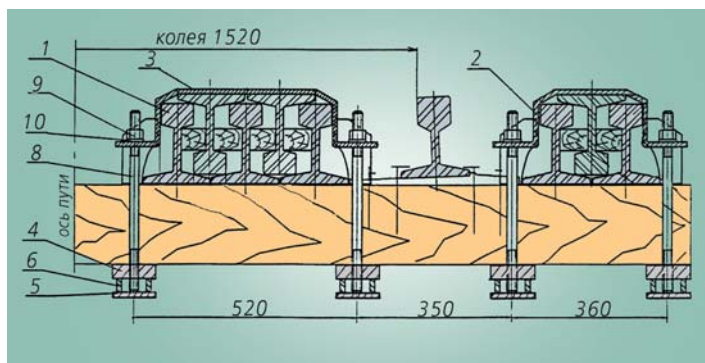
Конструкция разгружающего пакета: 1 – рельсы железнодорожные Р 65; 2 и 3 – скоба хомута; 4 и 5 – планка хомута с резьбой; 6 – ограничитель планок; 7 – щека скобы; 8 – шпилька М24*400; 9 – гайка М24; 10 – шайба 24
